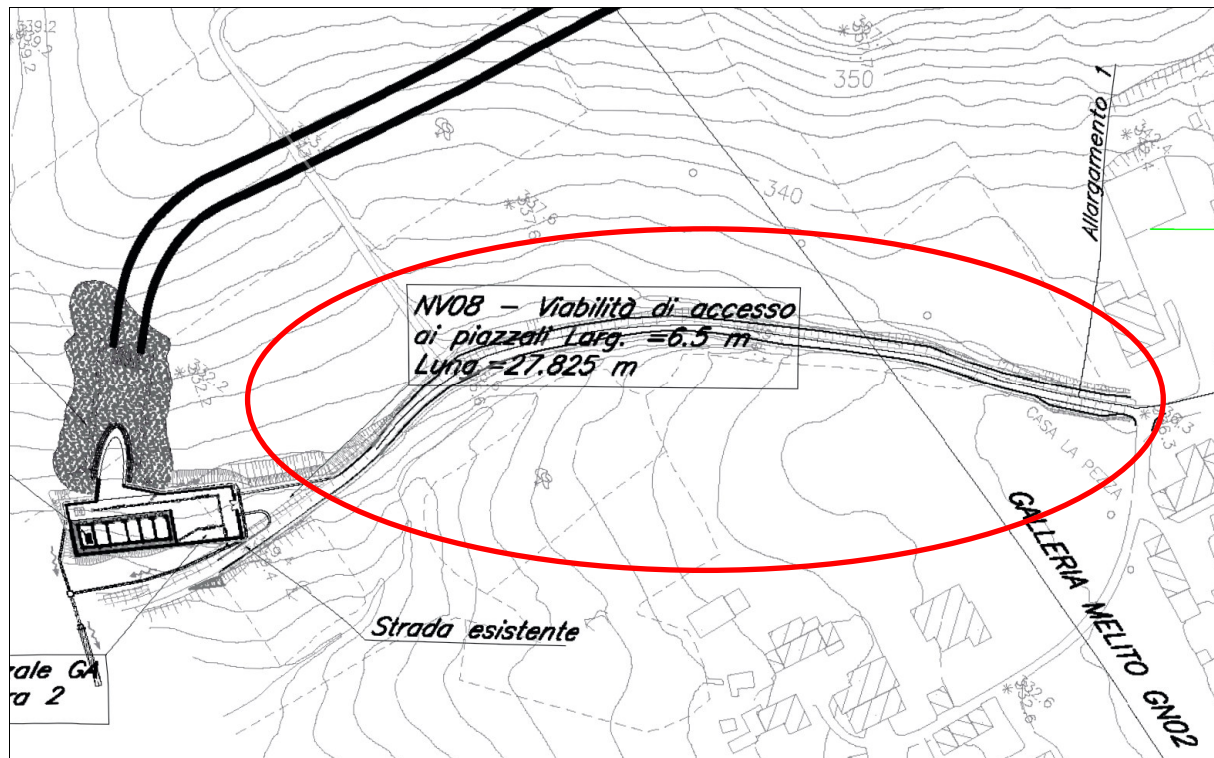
Stralcio planimetrico con l'individuazione dell'intervento
